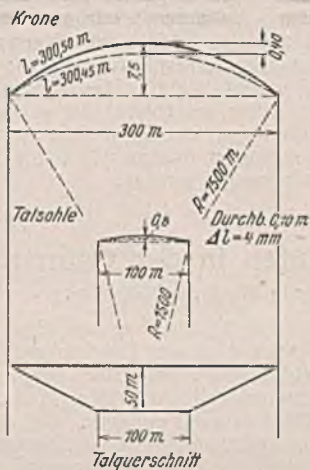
Grundriß einer gekrümmten Kernmauer mit Verschiebungsmaßen.
